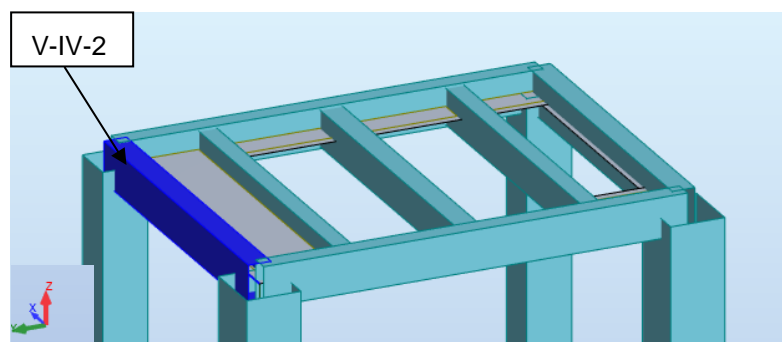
Identificação da Viga V-IV-2 – Robot Structural Analysis
